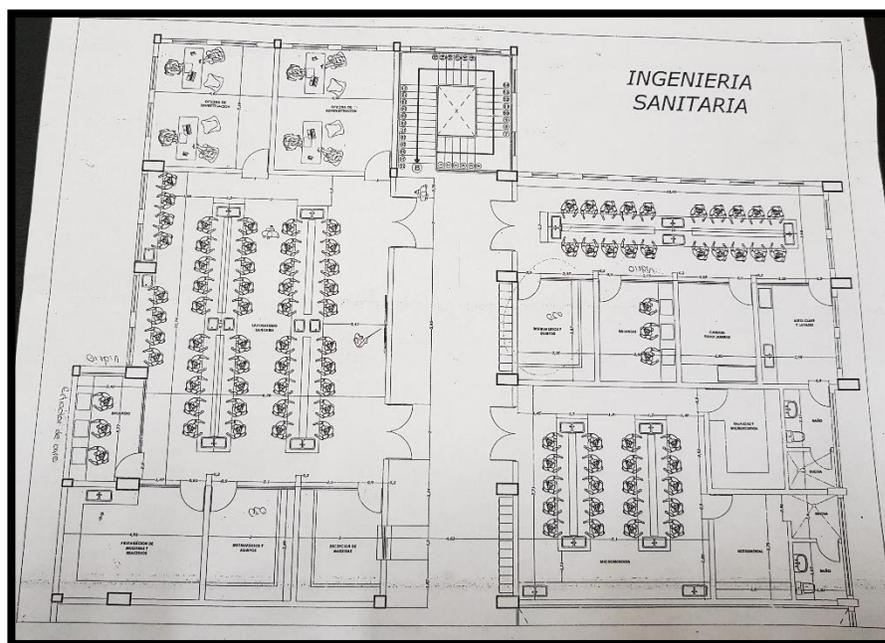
PLANO DE PLANTA ALTA DEL LABORATORIO DE HIDRÁULICA
